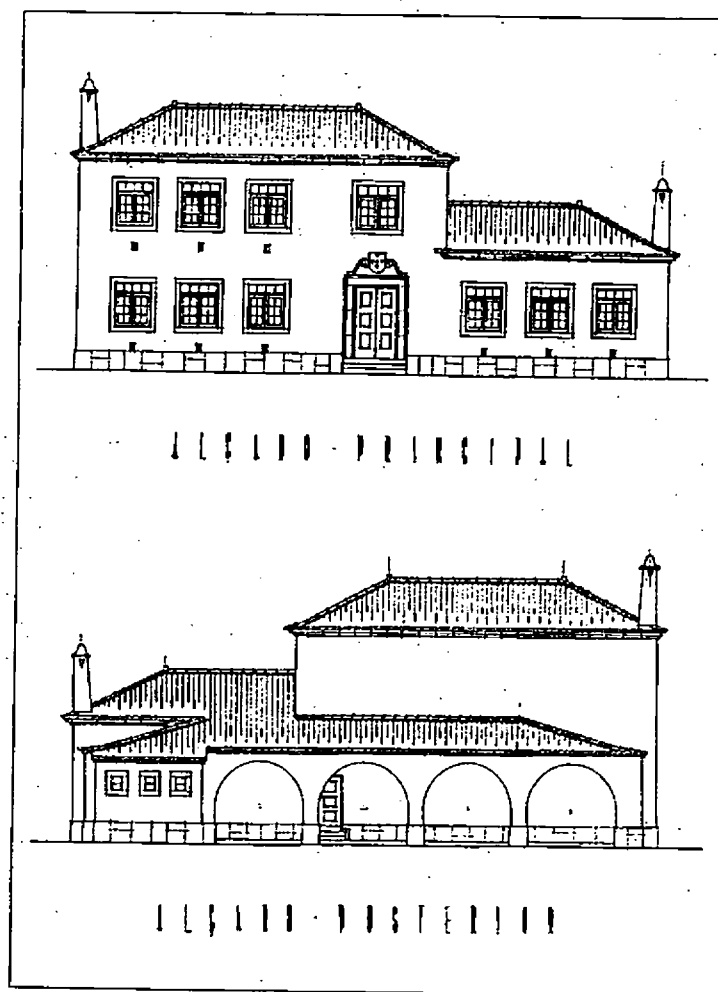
Alçado do edifício da escola da Pena construído à cota mais elevada.
